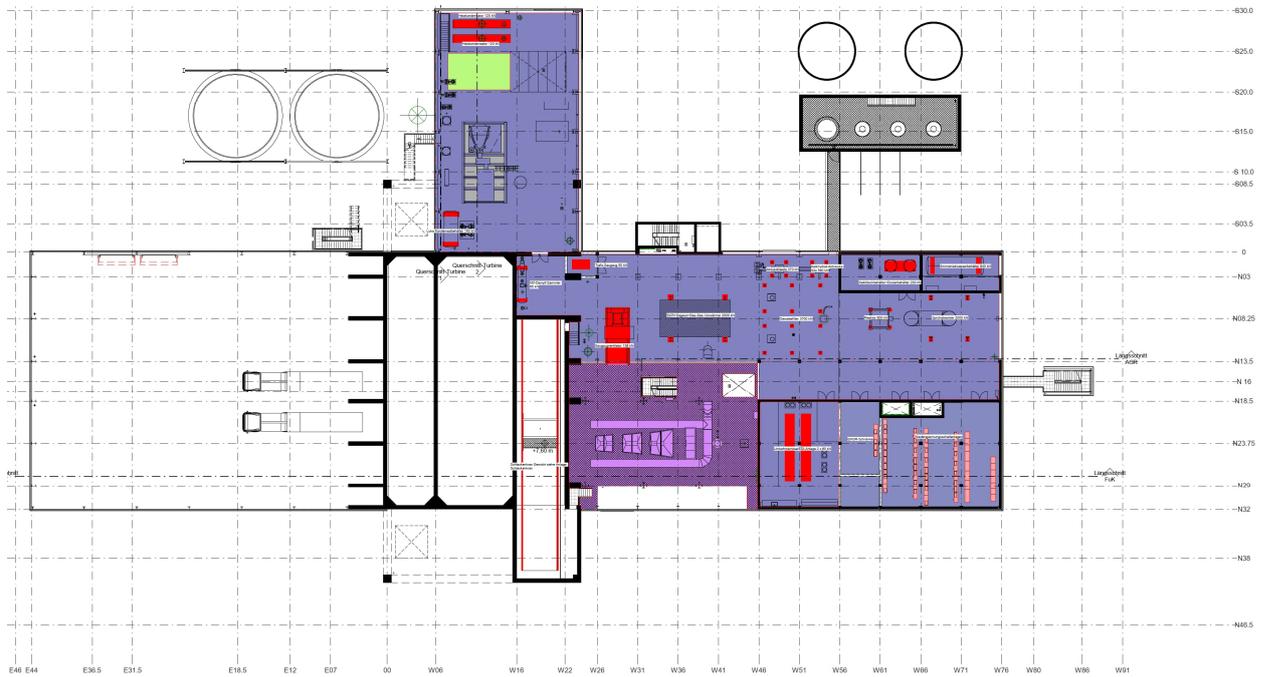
Nutzlasten Grundriss +6.48m
